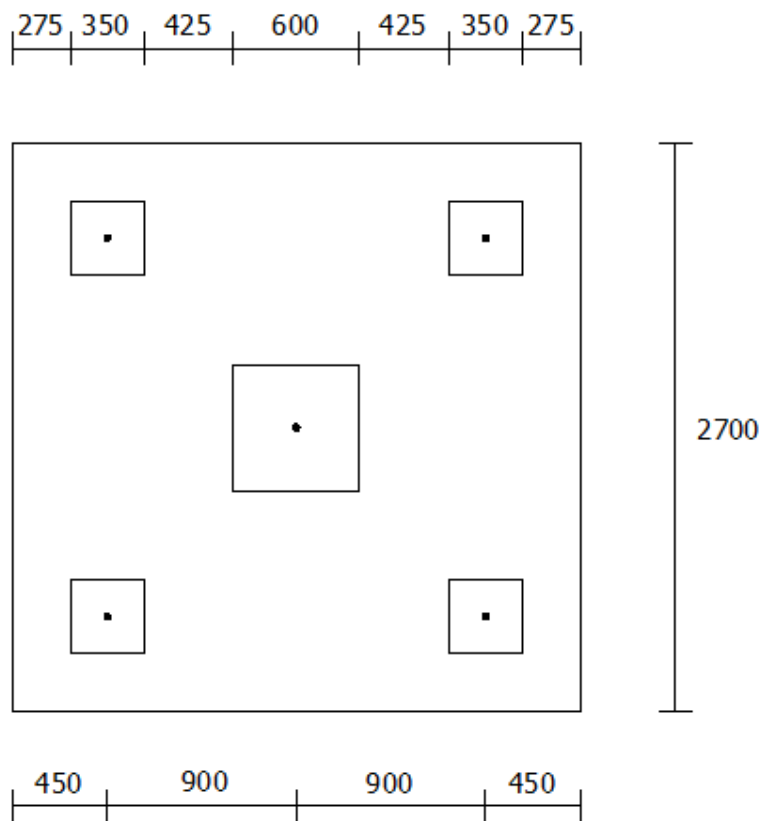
Geometría de la zapata (medidas en mm).
